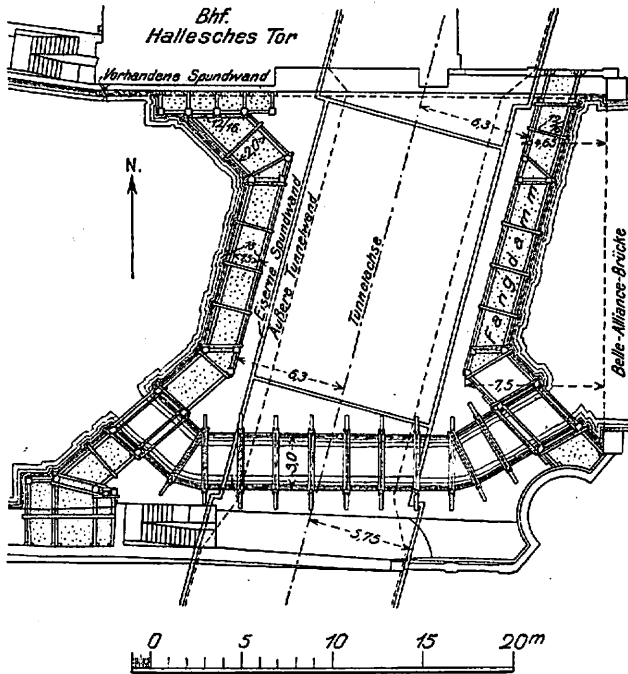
Landwehrkanal-Unterführung (Bauabschnitt I) Grundriß.
